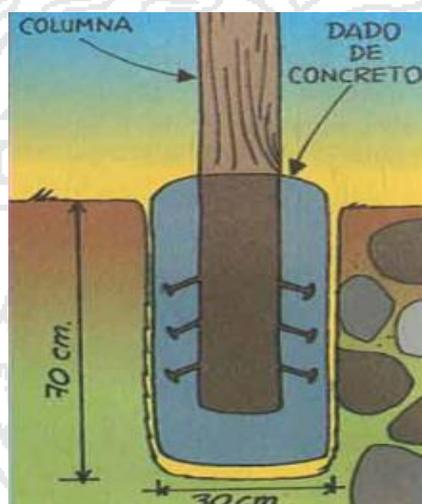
detalle de dado de concreto para columna en cobertizo.
